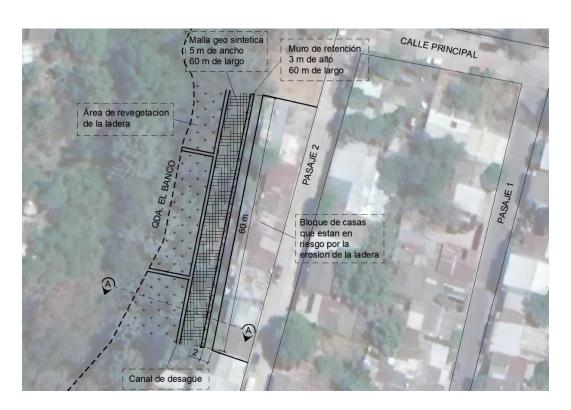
Vista en planta de la distribución de las obras propuestas en el terreno (mayo, 2021).
